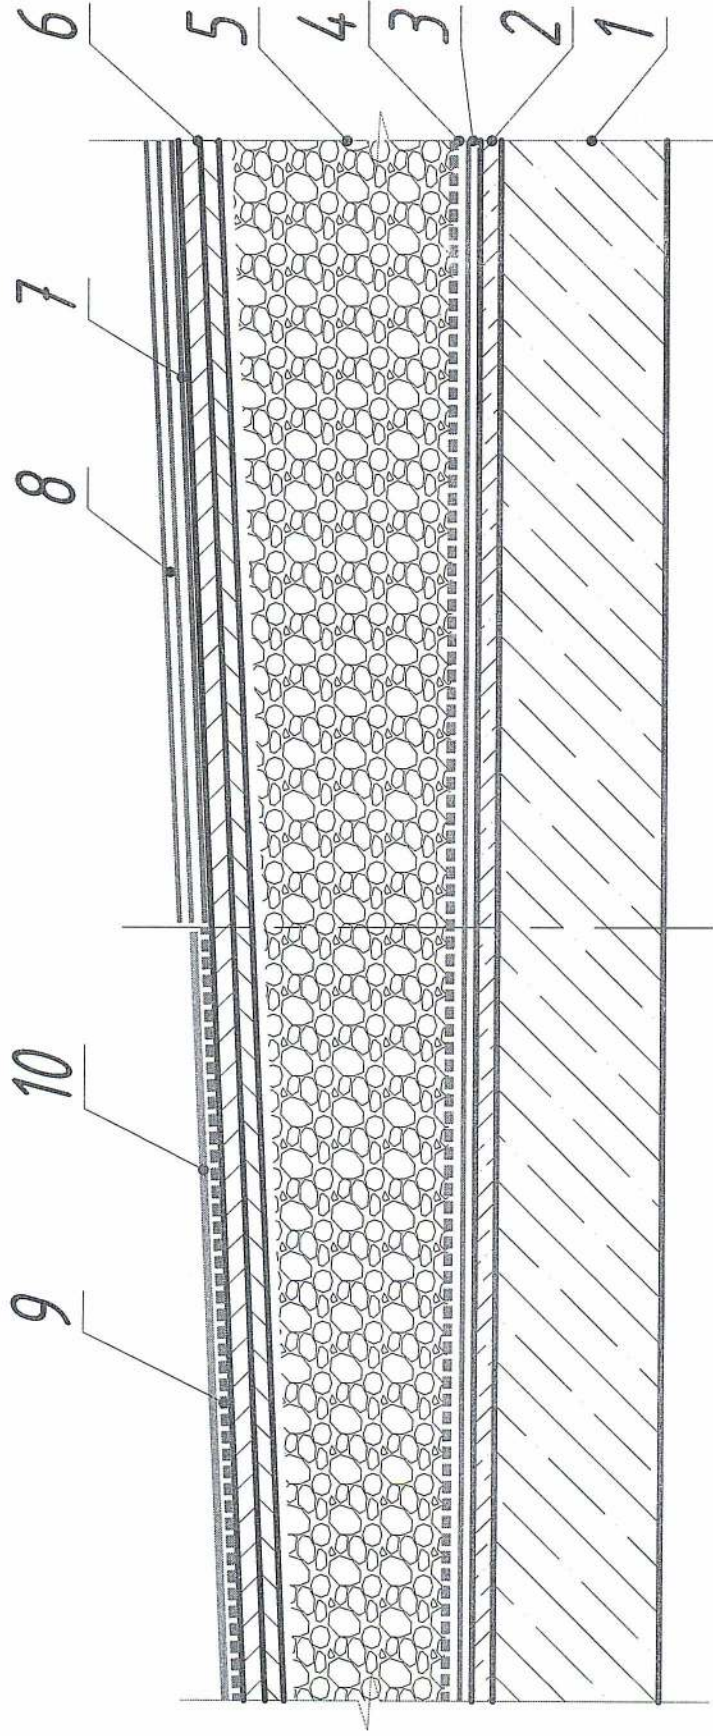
Принципиальная схема конструктивного исполнения настила бесчердачного покрытия выполняемого по железобетонному основанию (неэксплуатируемая кровля со сборной стяжкой)
